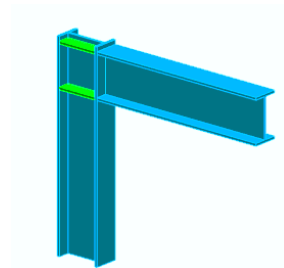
Pormenor em 3D da ligação Pilar - Viga
